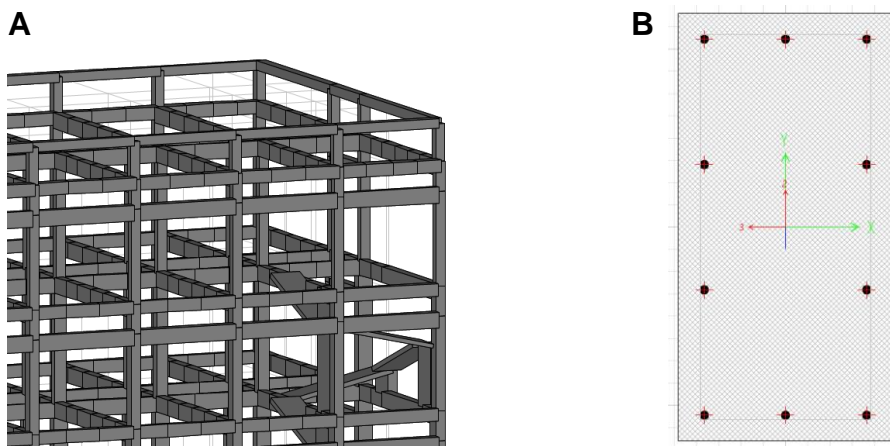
Modelação das vigas e Pilares: (A) Vista 3D; (B) Section Designer do SAP2000 [6]
